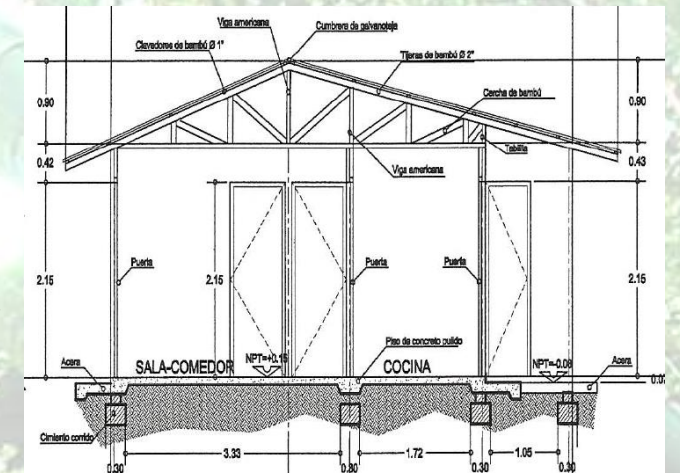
SECCIÓN DE MODELO DE VIVIENDA EN MÉXICO
